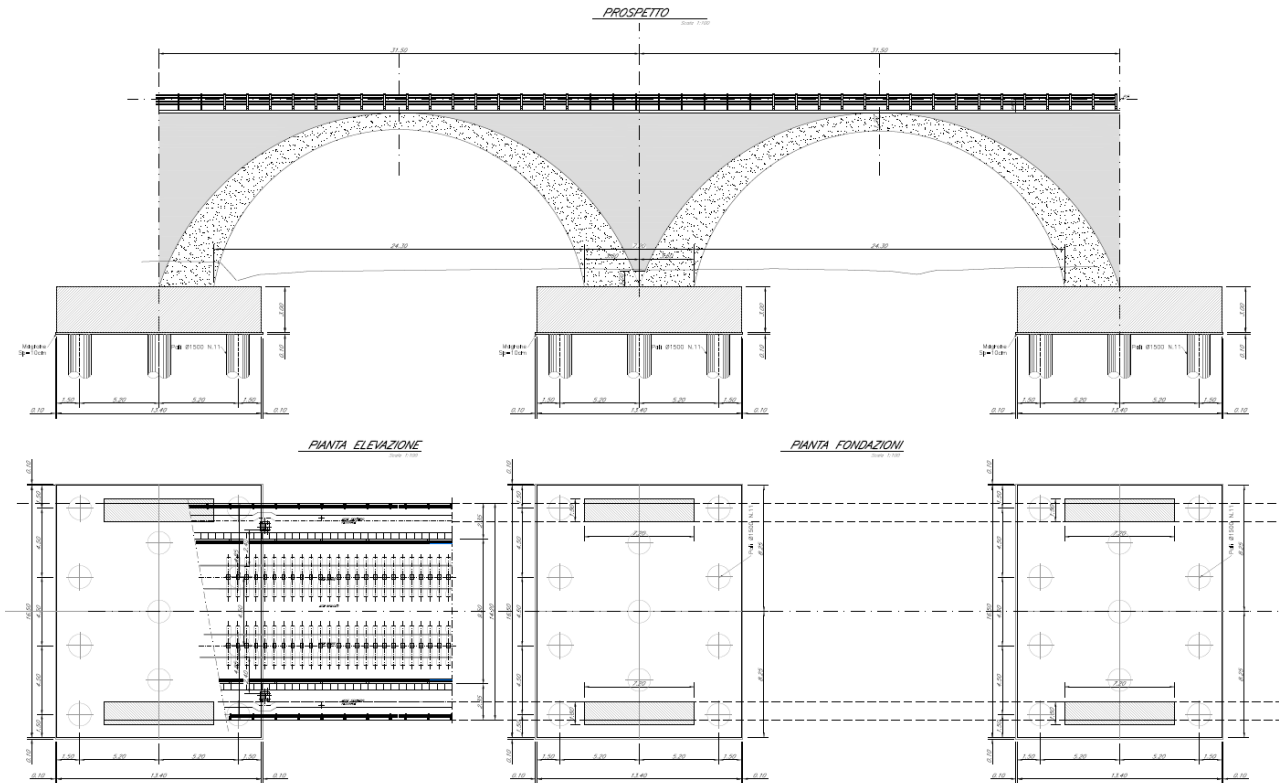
Prospetto e Pianta Fondazioni Gallerodotto
